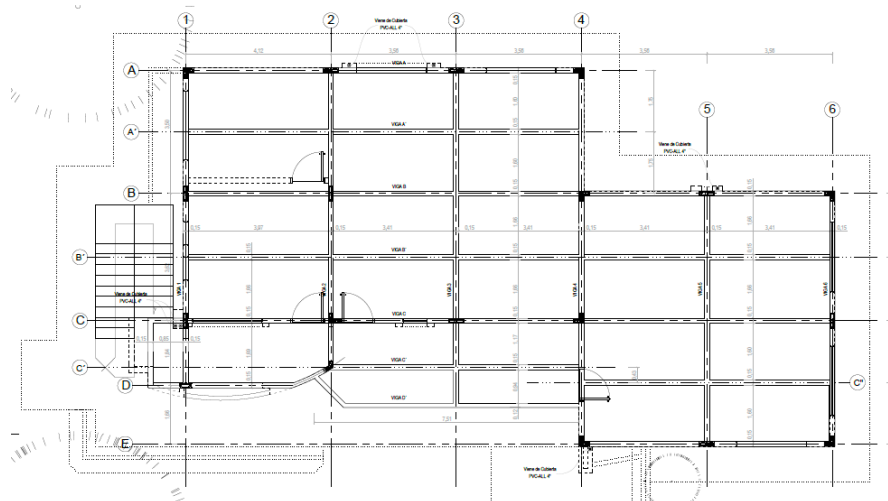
Planta Estructura Actual Cafamaz.
